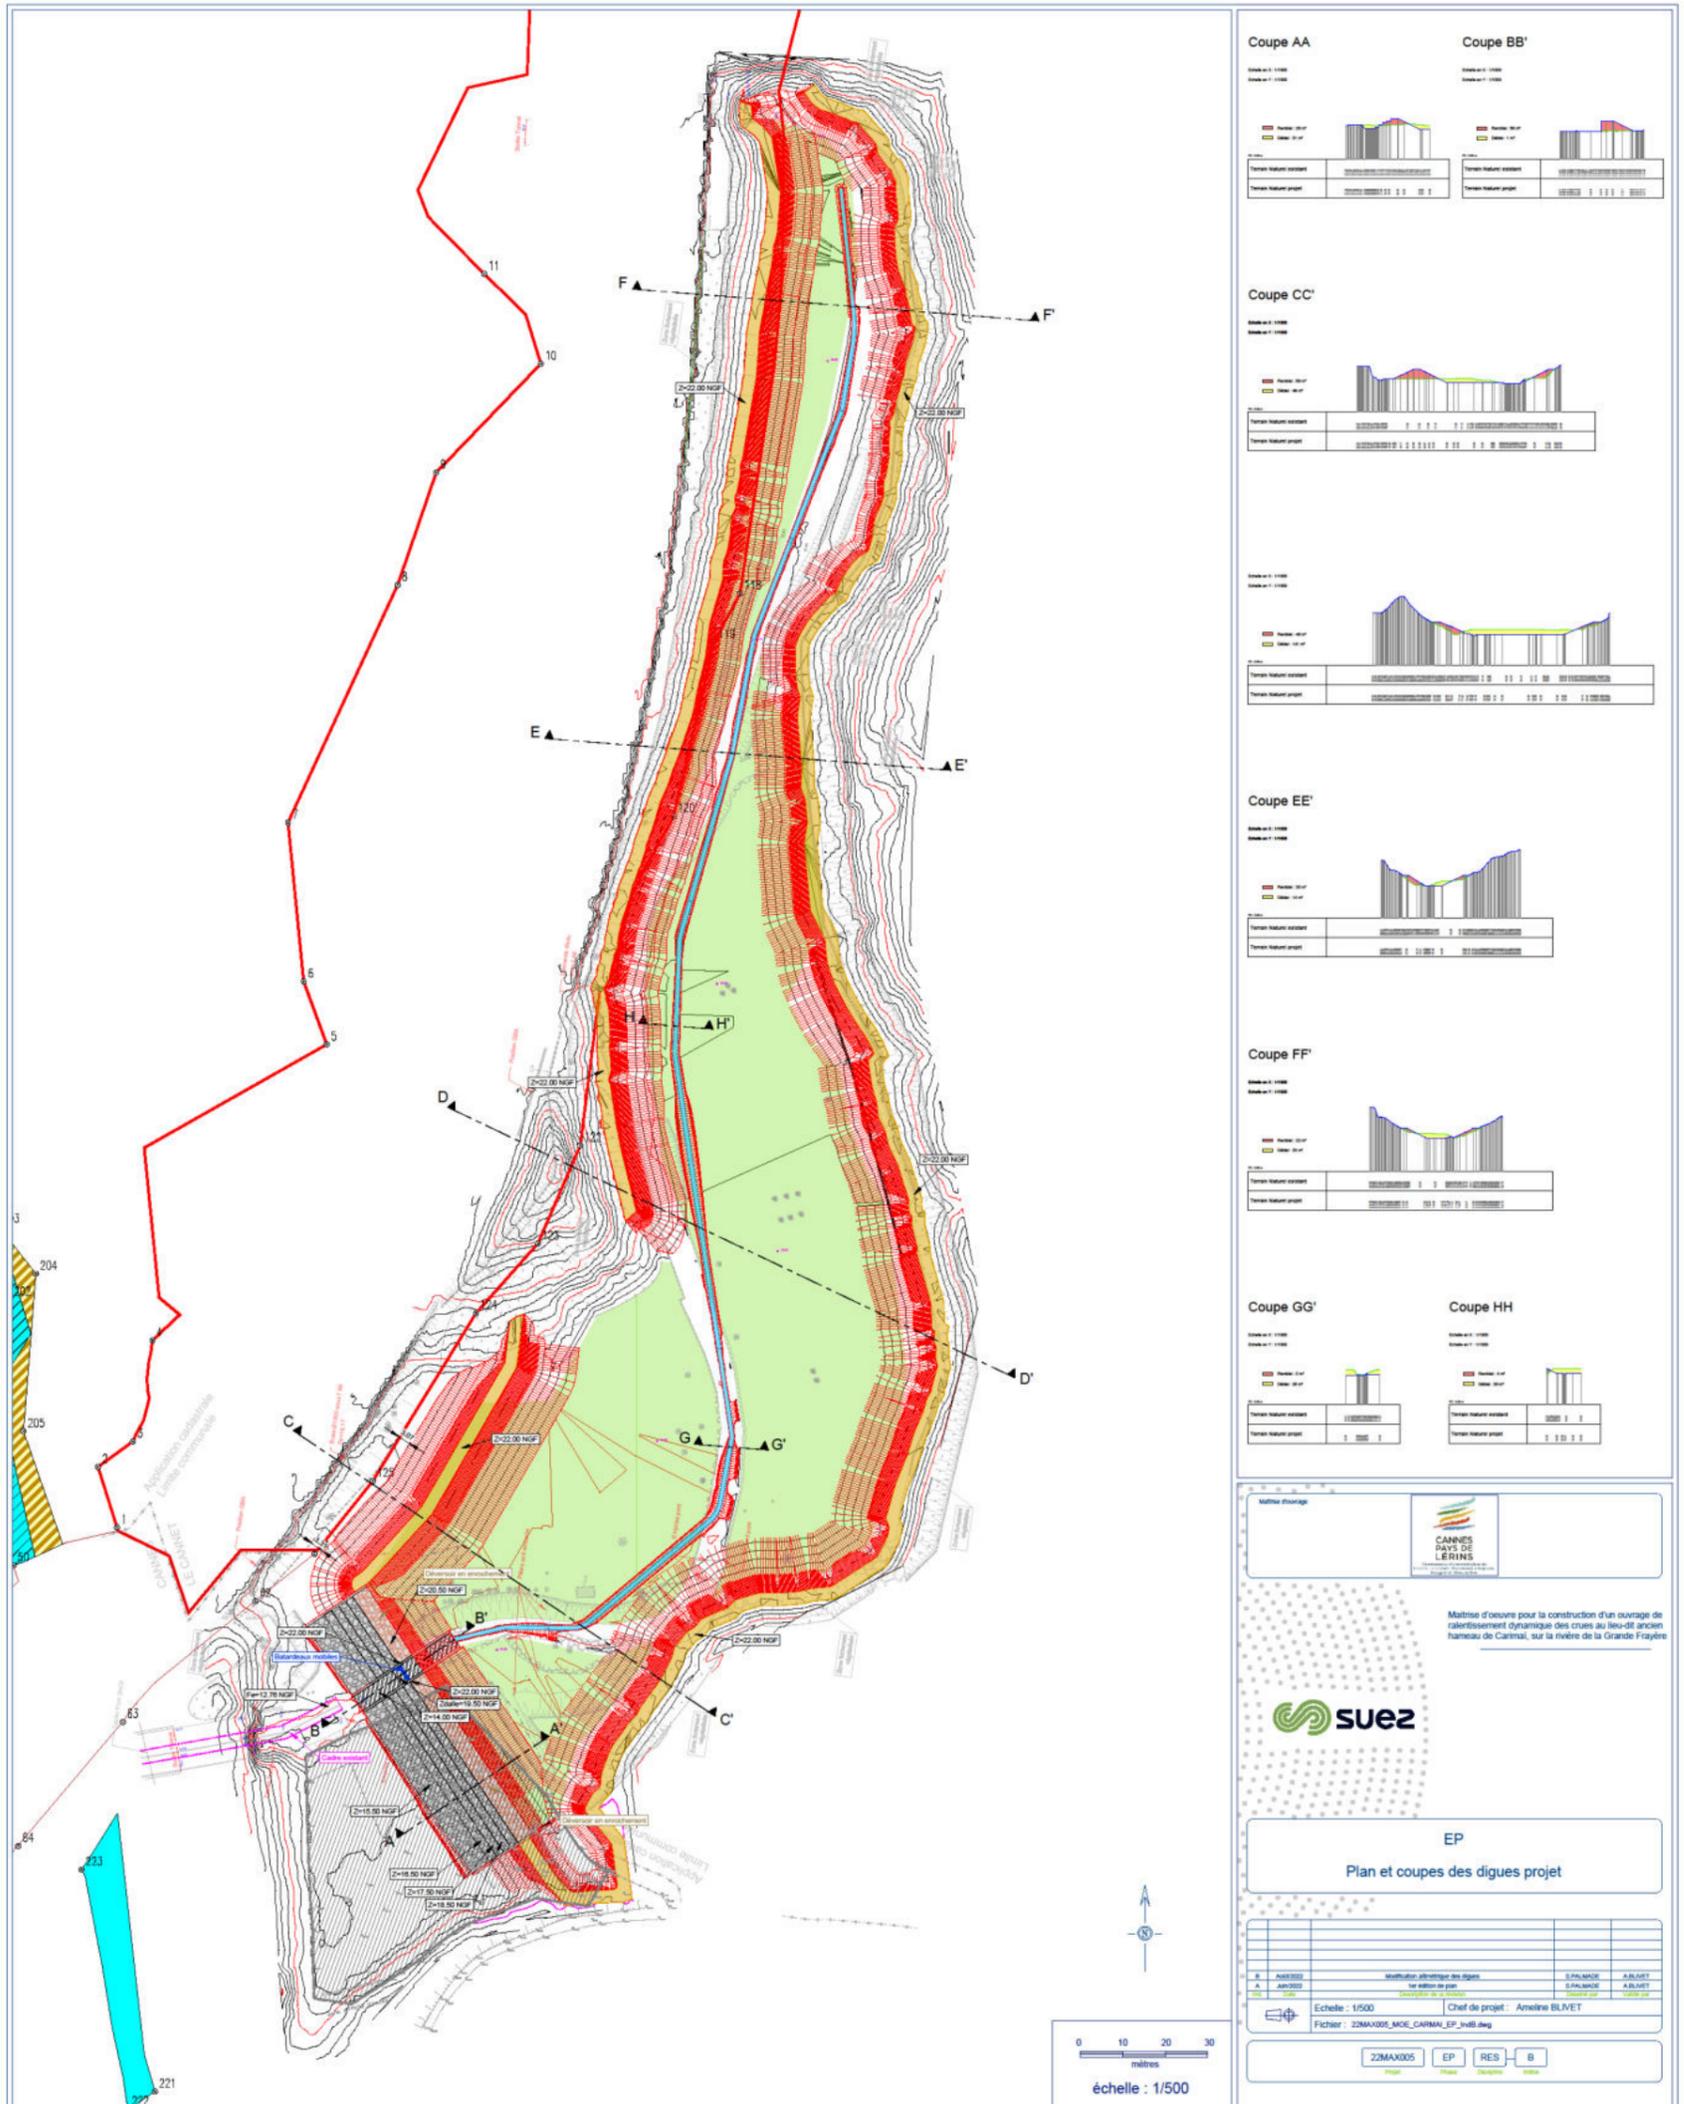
Plan et coupes des digues (Source : Suez Consulting)
